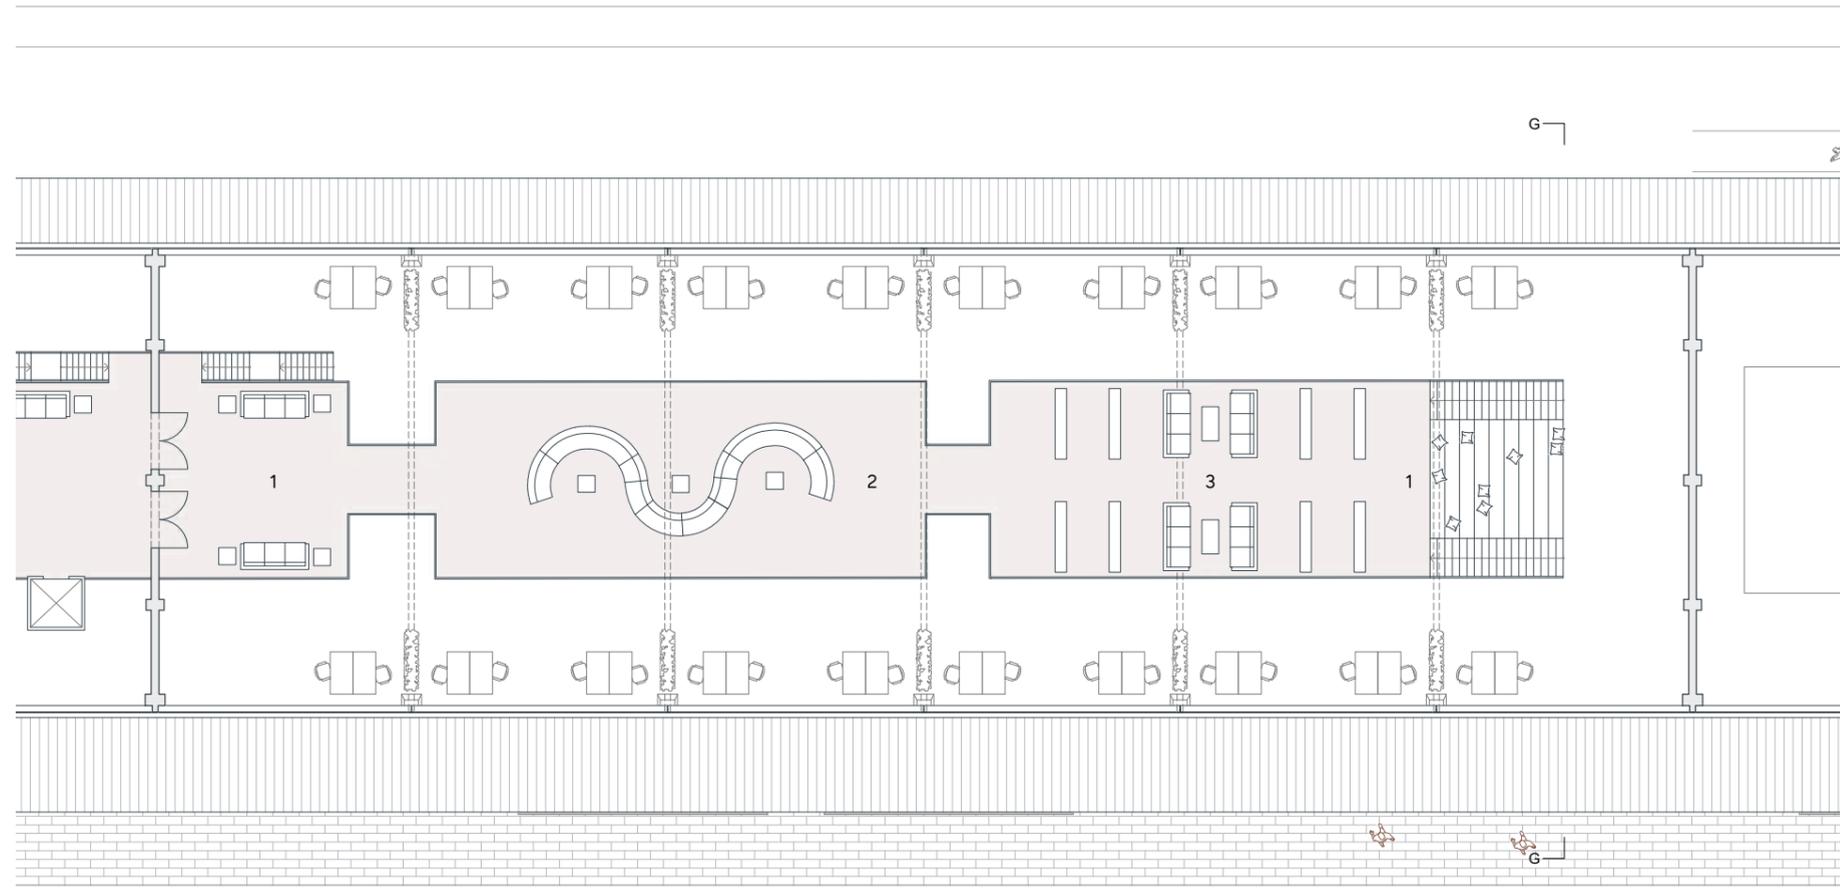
Stückgutshuppen: Bauliche Veränderungen, Co-Working-Space, Halle 2, Obergeschoss M 1:250
